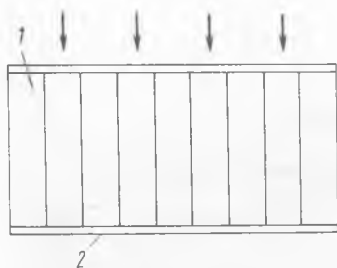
Мембрана из плит покрытия или перекрытия (1), соединенная с торцовыми сжатыми и растянутыми балками (2)
